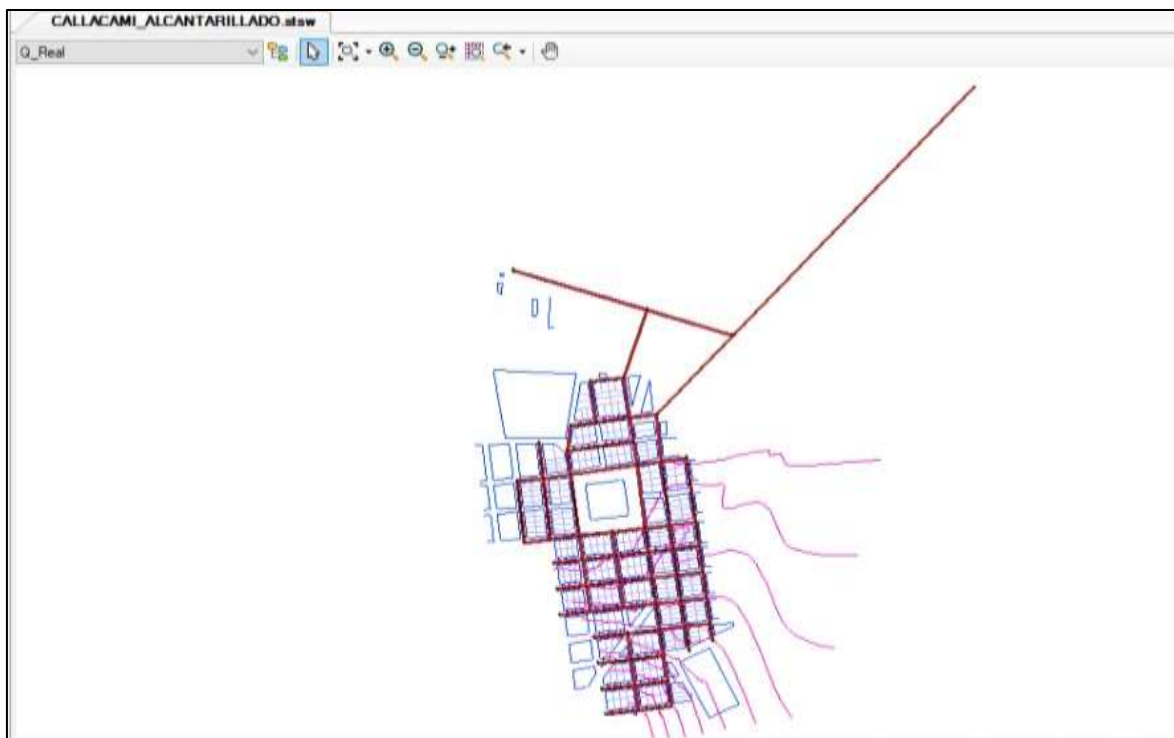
Diseño de Alcantarillado con el modelo SewerCAD.
